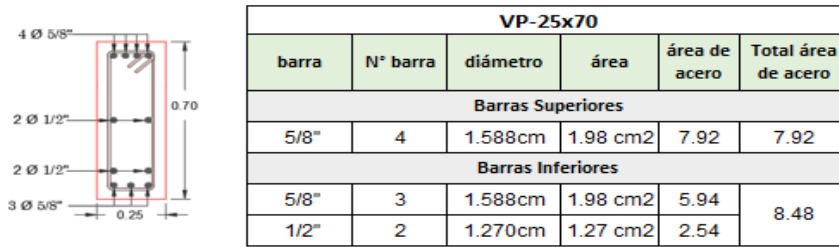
Detalle de las Vigas del Módulo N° 1 y N° 2
